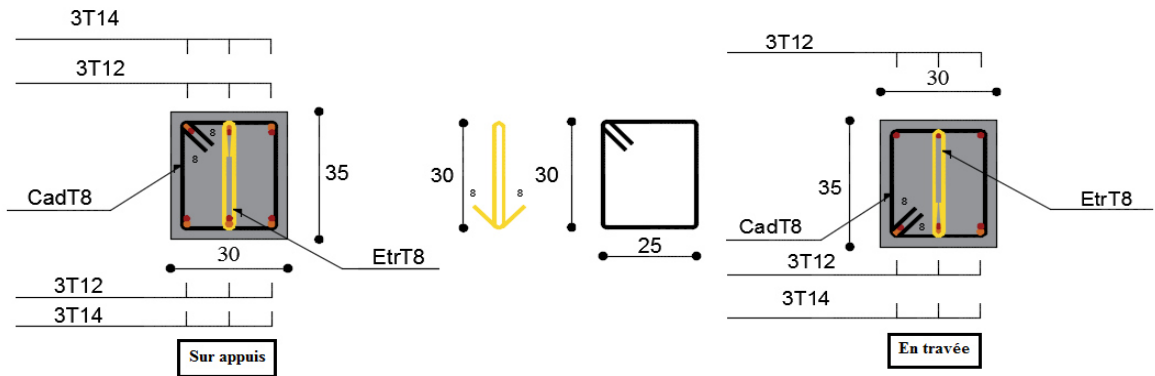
schéma de ferrailage des poutres secondaire en travée et en appuis (Bureau).
